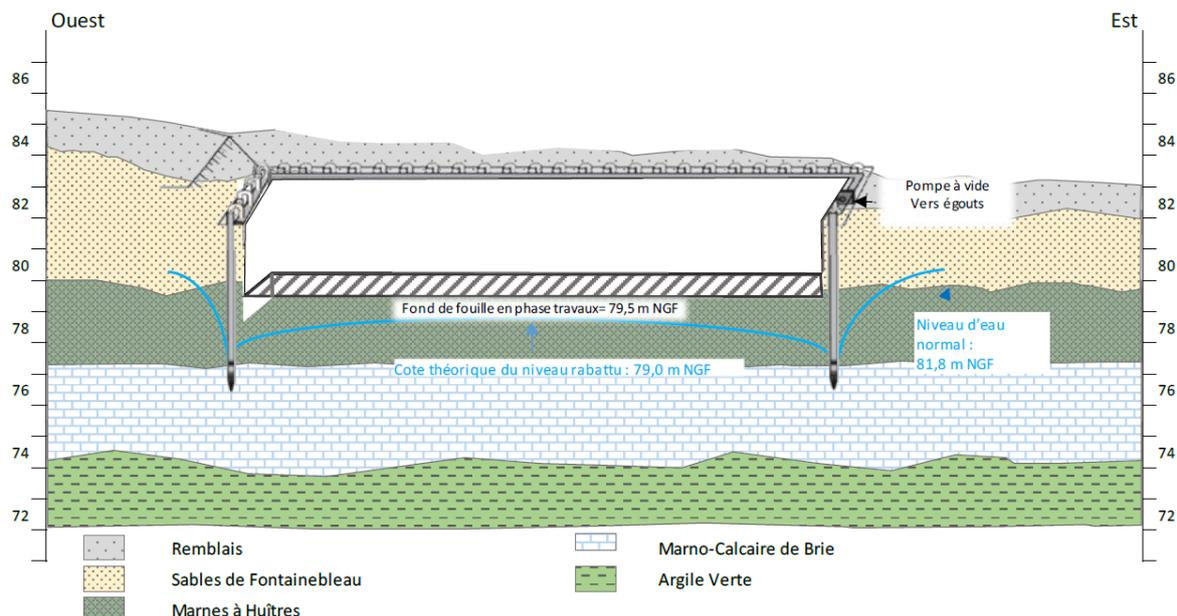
Vue schématique en coupe du dispositif de pointes filtrantes à mettre en place au droit du projet
